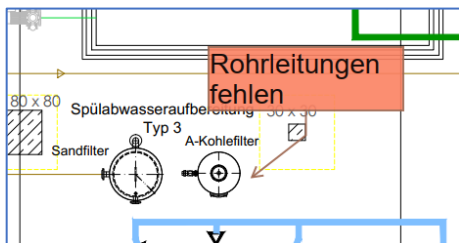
2.4.33 2021-10-22 905 472 Wassertechnik Grundriss E-2 Aufstellplan
